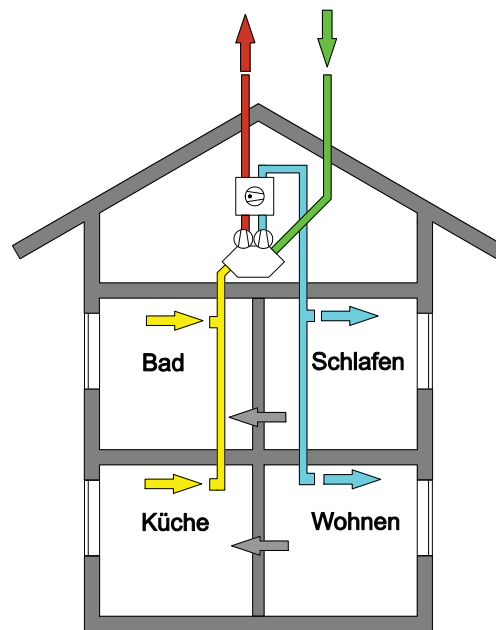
Zentrale Lüftungsanlage mit WRG und Lüftungswärmepumpe zur Luftnachheizung und Trinkwarmwassererwärmung
